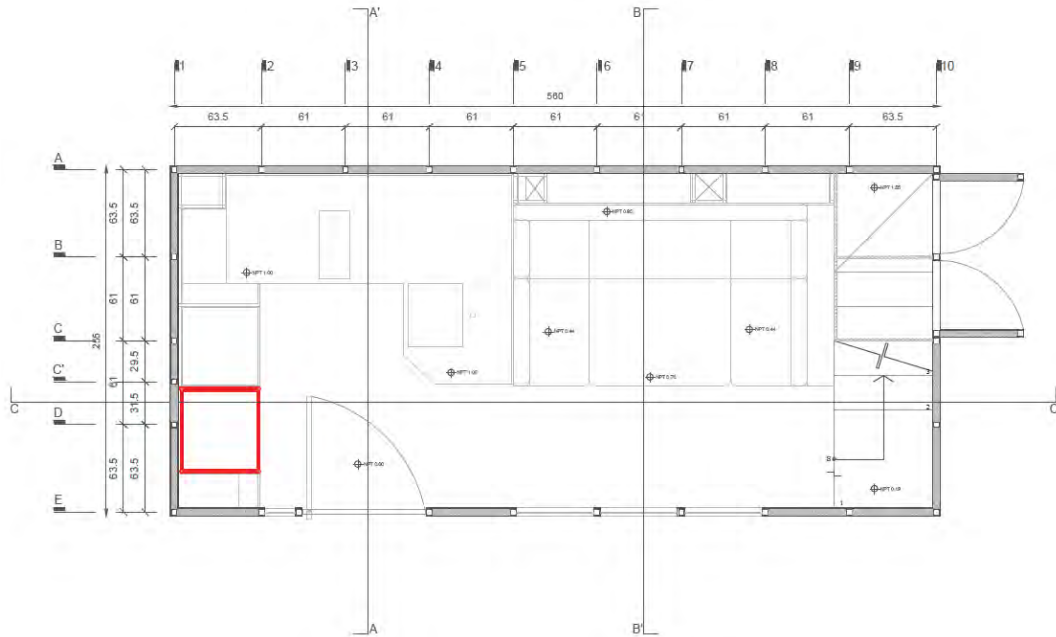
Planta, planta baja. Muebles que generan aguas grises.
